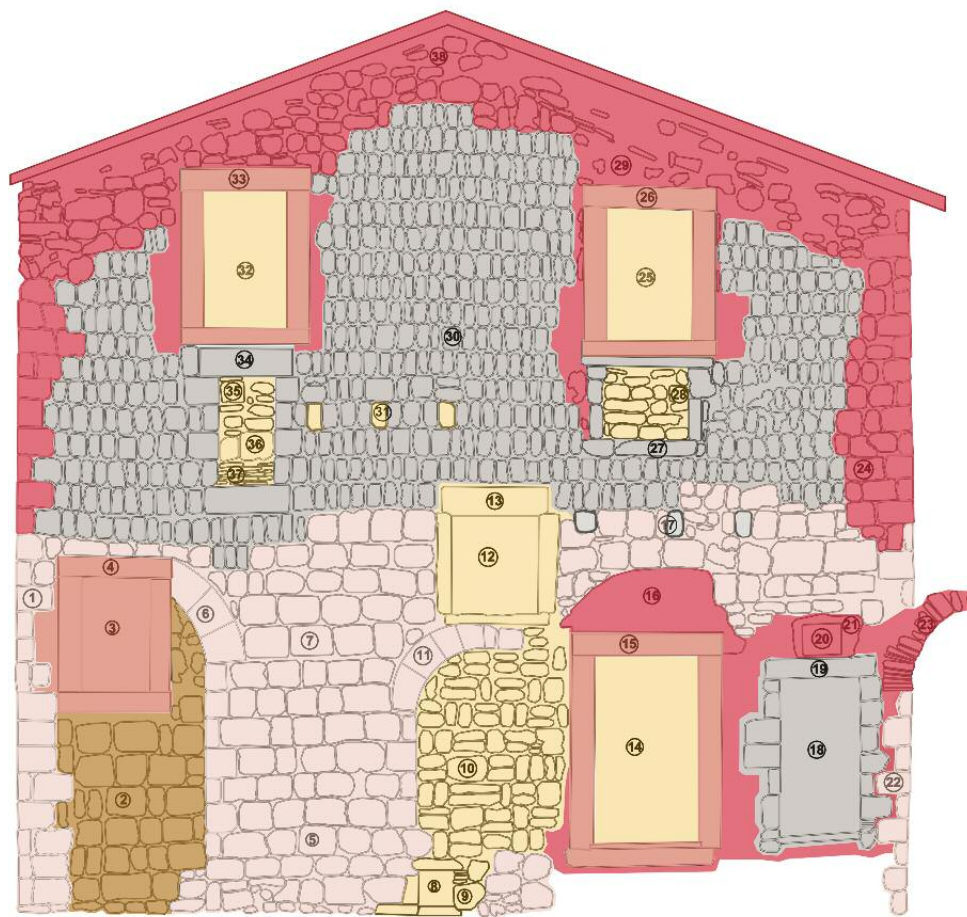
Individuazione delle Unità Stratiigrafiche Murarie del prospetto dell'edificio.
